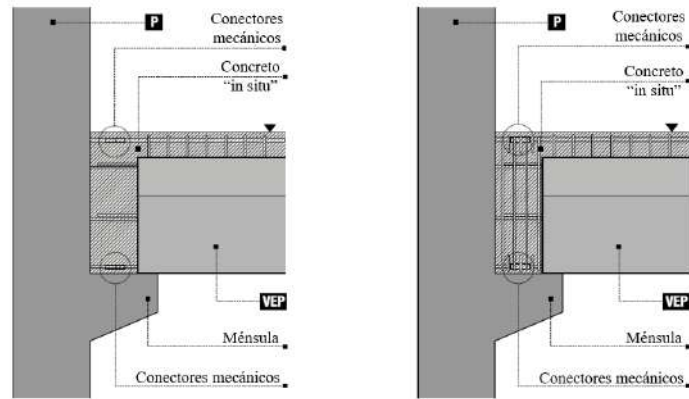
Conexión húmeda viga – columna con conectores mecánicos.
